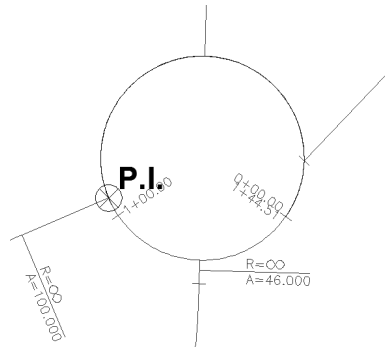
Intersecção em Planta entre o eixo do Ramo 3 e a Rotunda A
